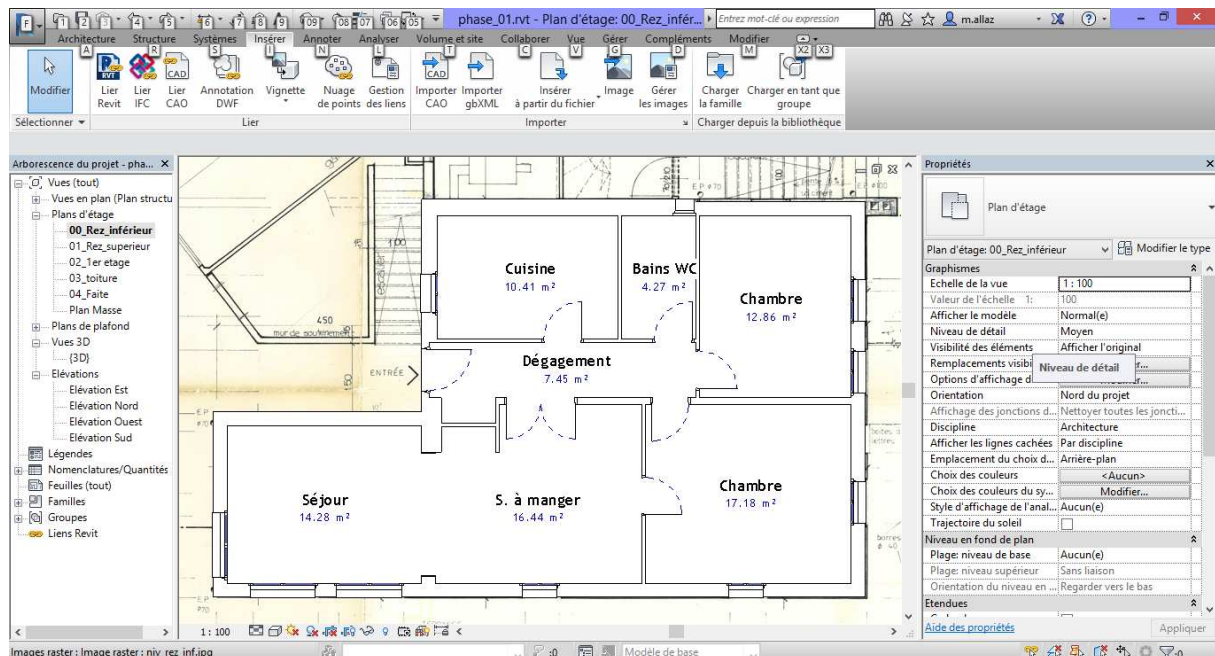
Modélisation d'un niveau (vue en plan) © Revit
